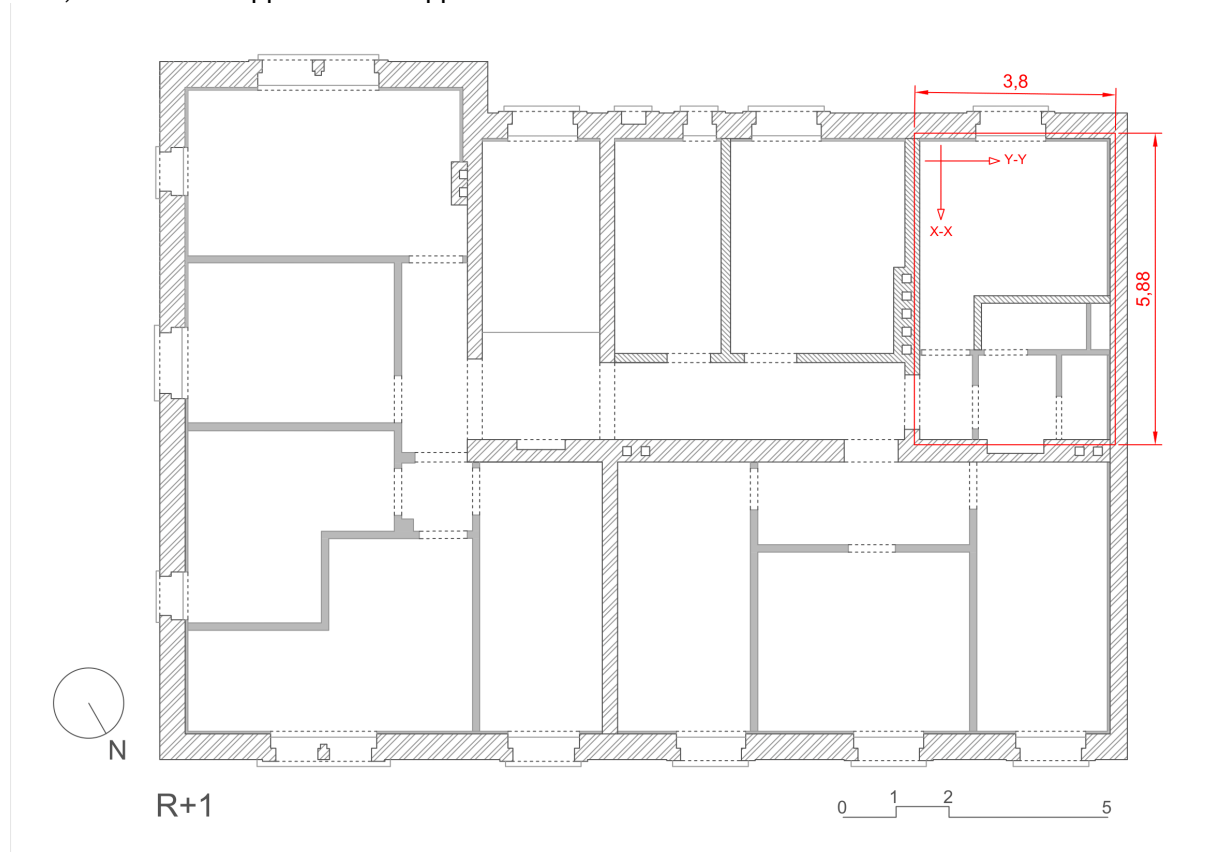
Plan du plancher étudié - ici plancher haut du R+1 - local de l'angle sud-ouest.
